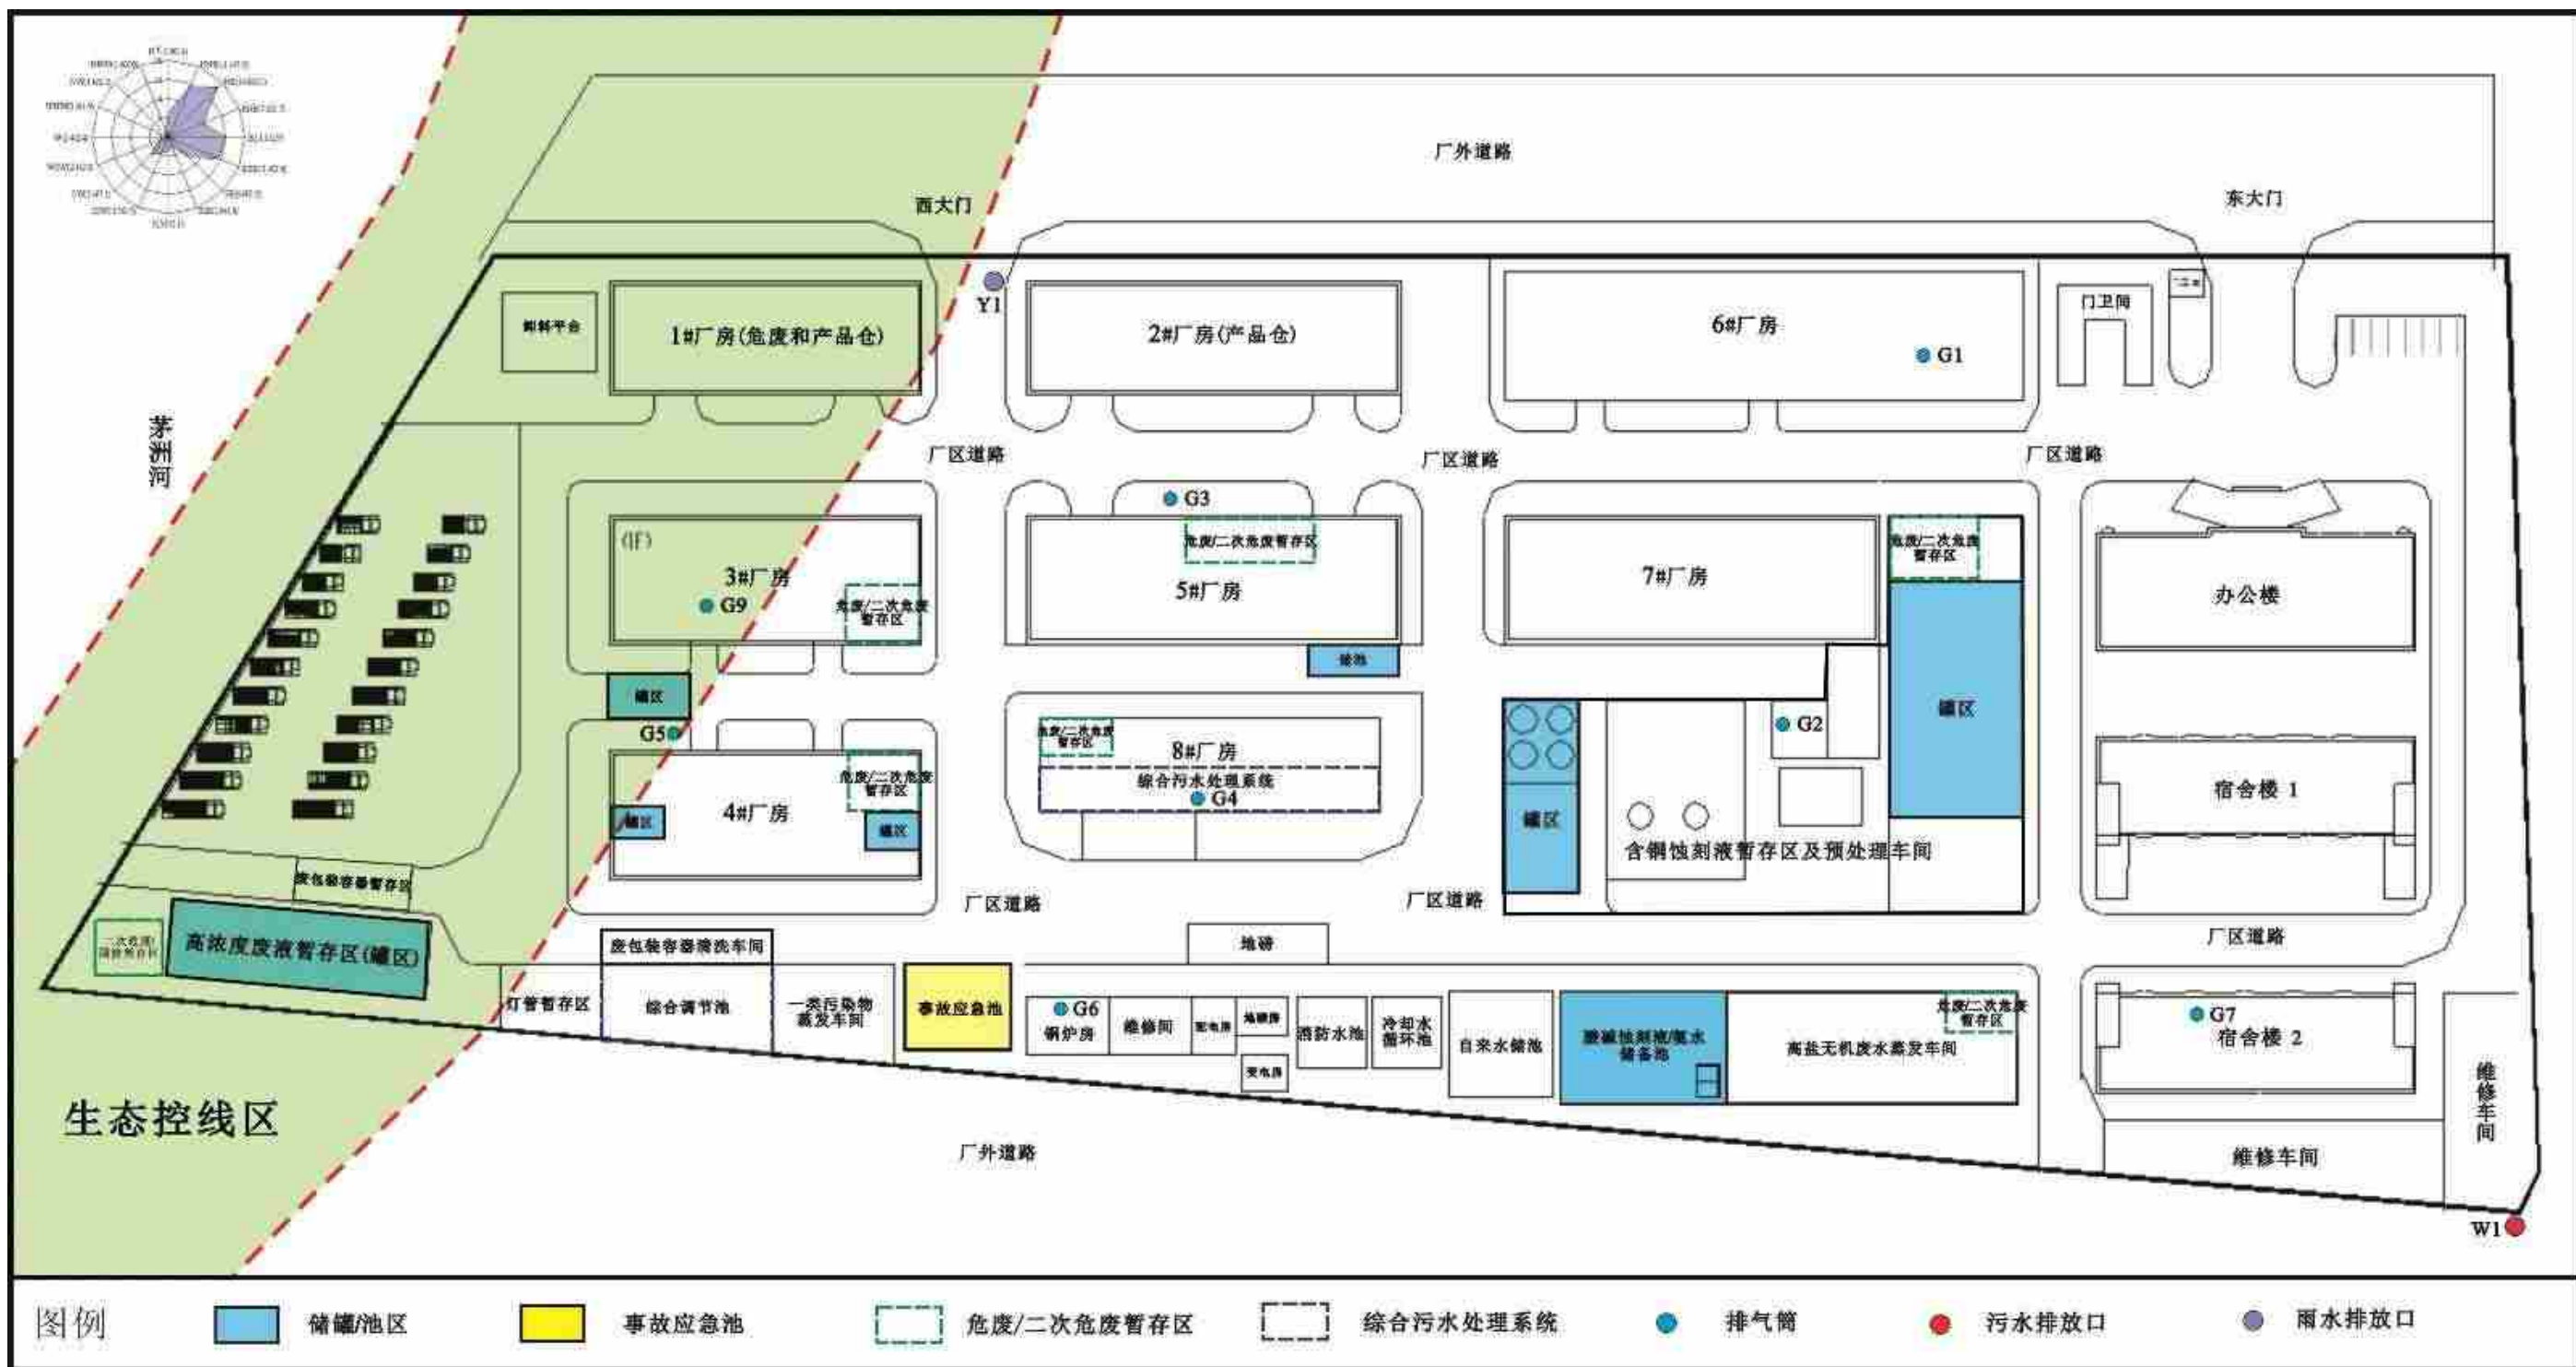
(1) 现有项目共和厂区厂区平面图
